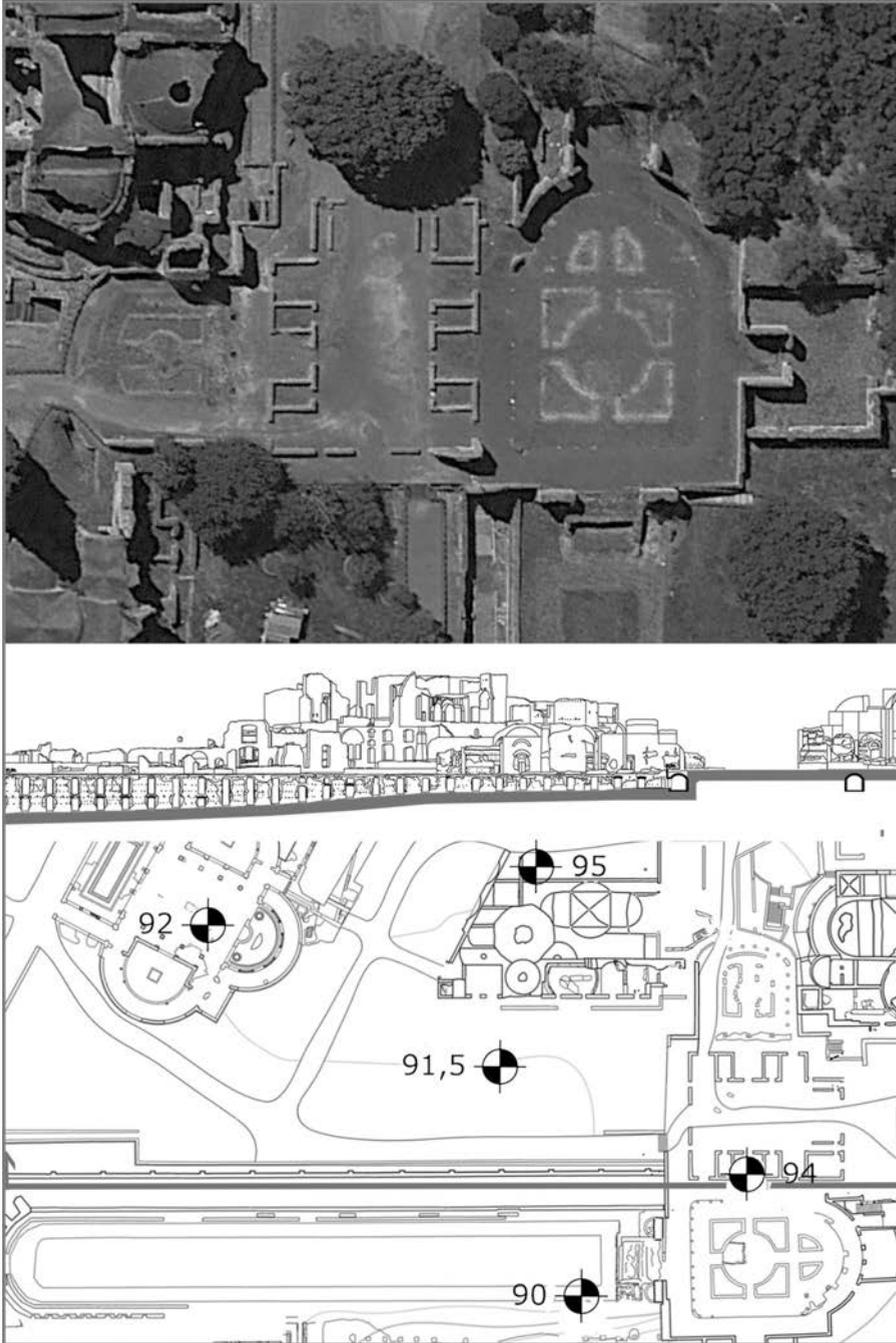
Vista planimetrica dall'alto e sezione orizzontale a quota 8.5msm del braccio meridionale del complesso delle Cento Camerelle (autore).
